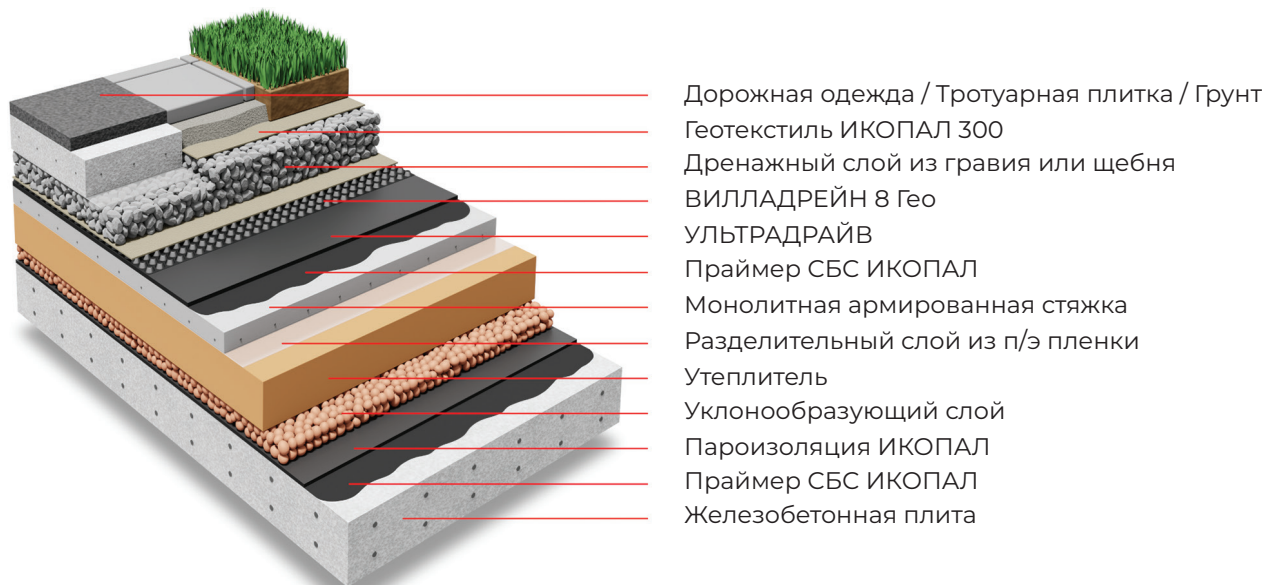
Вариант традиционной эксплуатируемой кровли с однослойным кровельным ковром и утеплителем из плитных материалов
